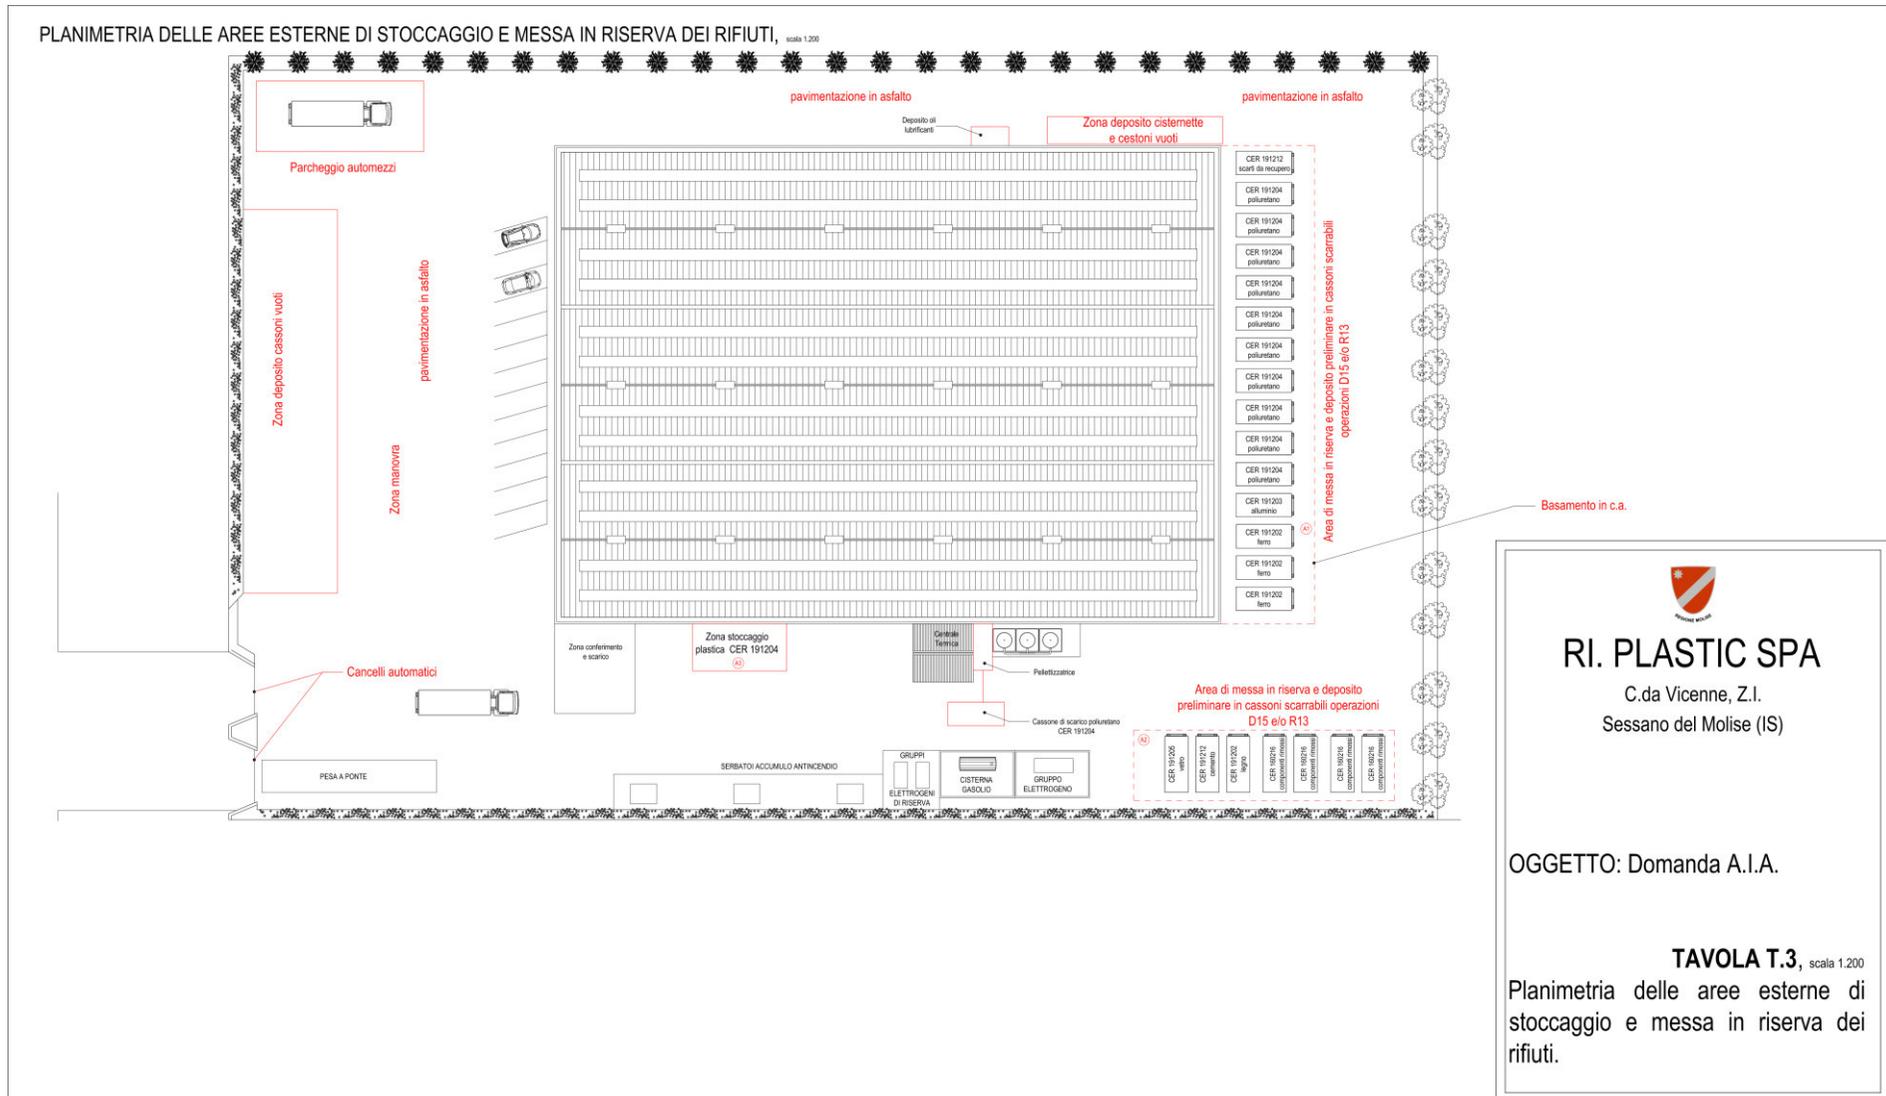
planimetria generale delle aree esterne dell'installazione: assetto "ante operam"
